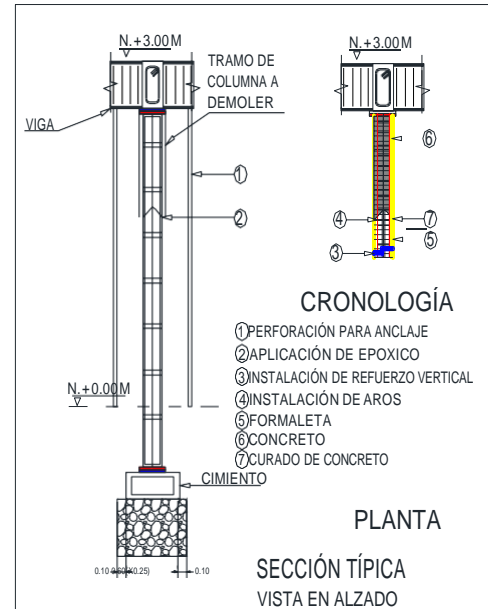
VISTA EN ALZADO DE LA COLUMNA CON REPARACIÓN.
